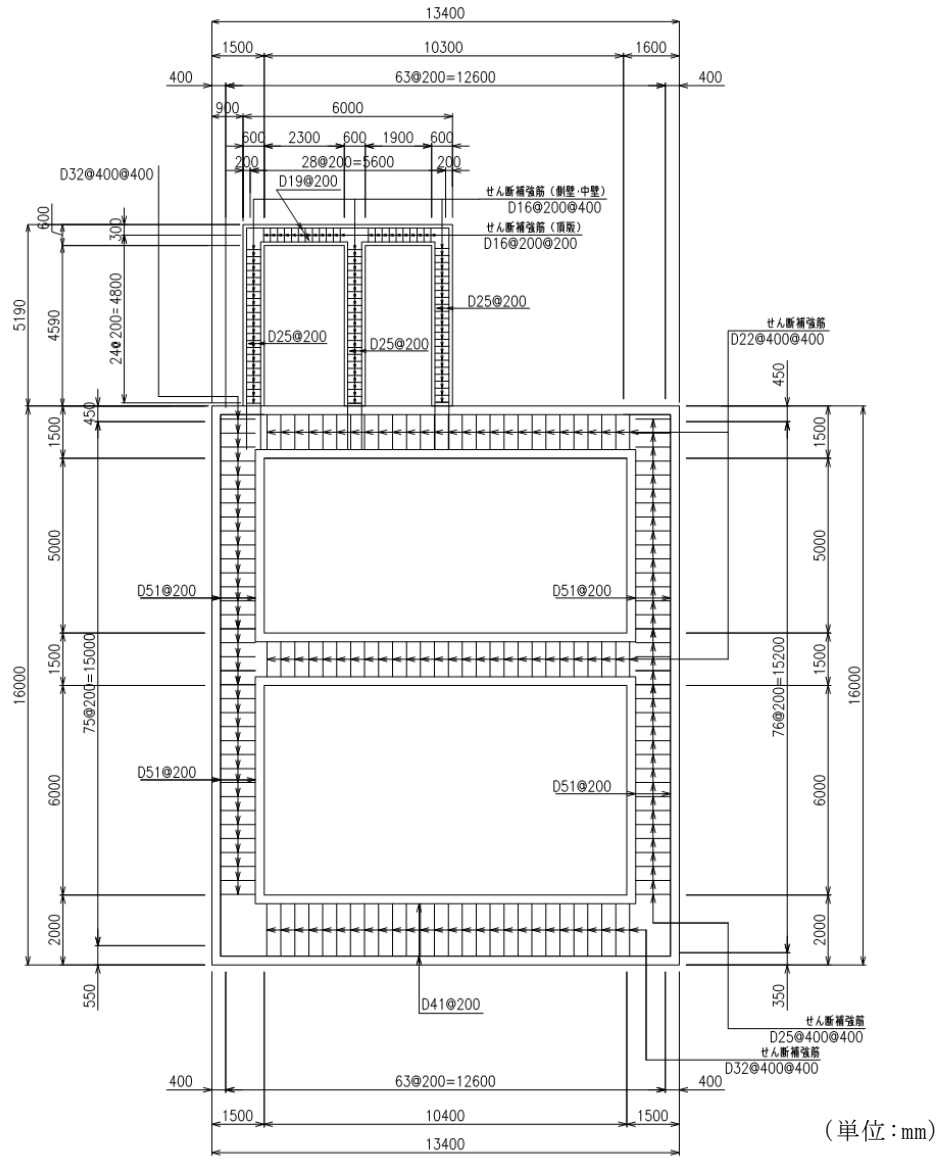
低圧原子炉代替注水ポンプ格納槽 概略配筋図 (E-E 断面)
